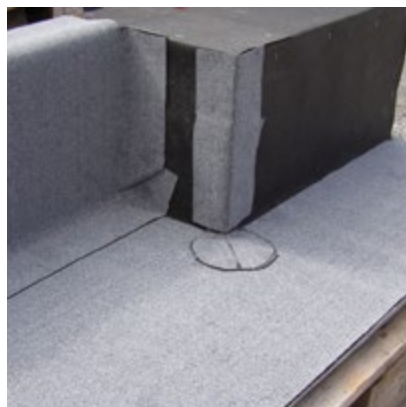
DETAILY – VYZTUŽENÍ KOUTŮ A ROHŮ Z ASFALTOVÝCH PÁSŮ
